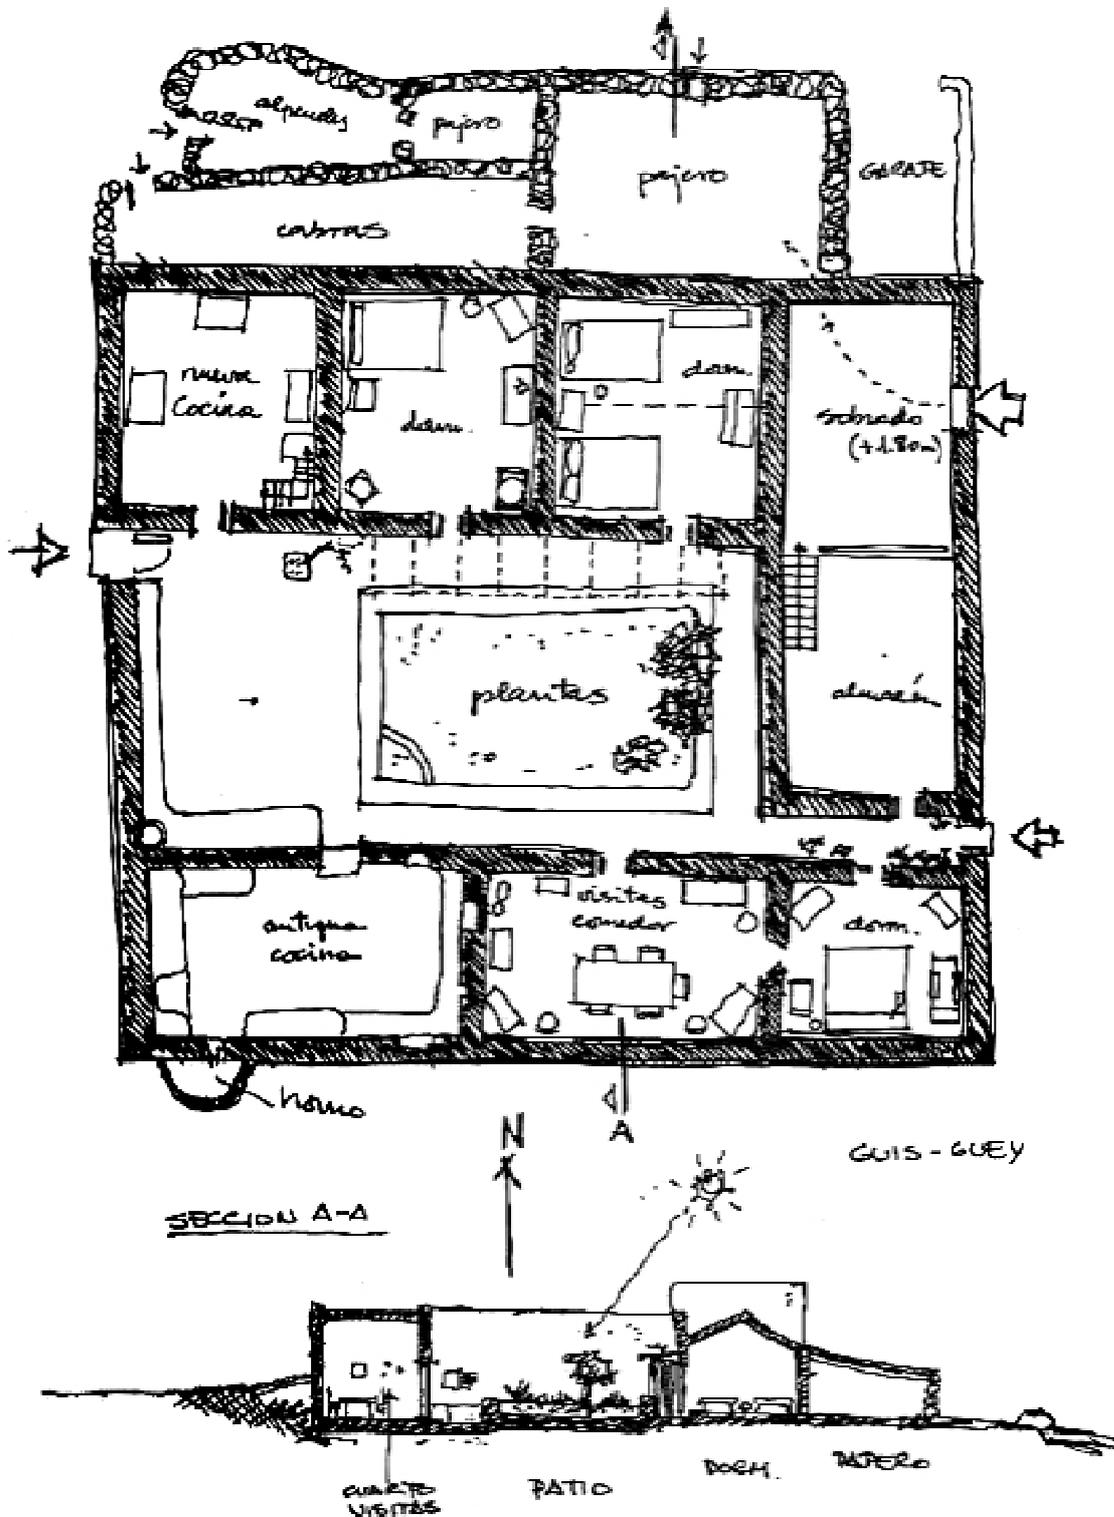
Planta y sección de vivienda tradicional de Fuerteventura. (Alonso Fernández-Aceytuno 1979)
